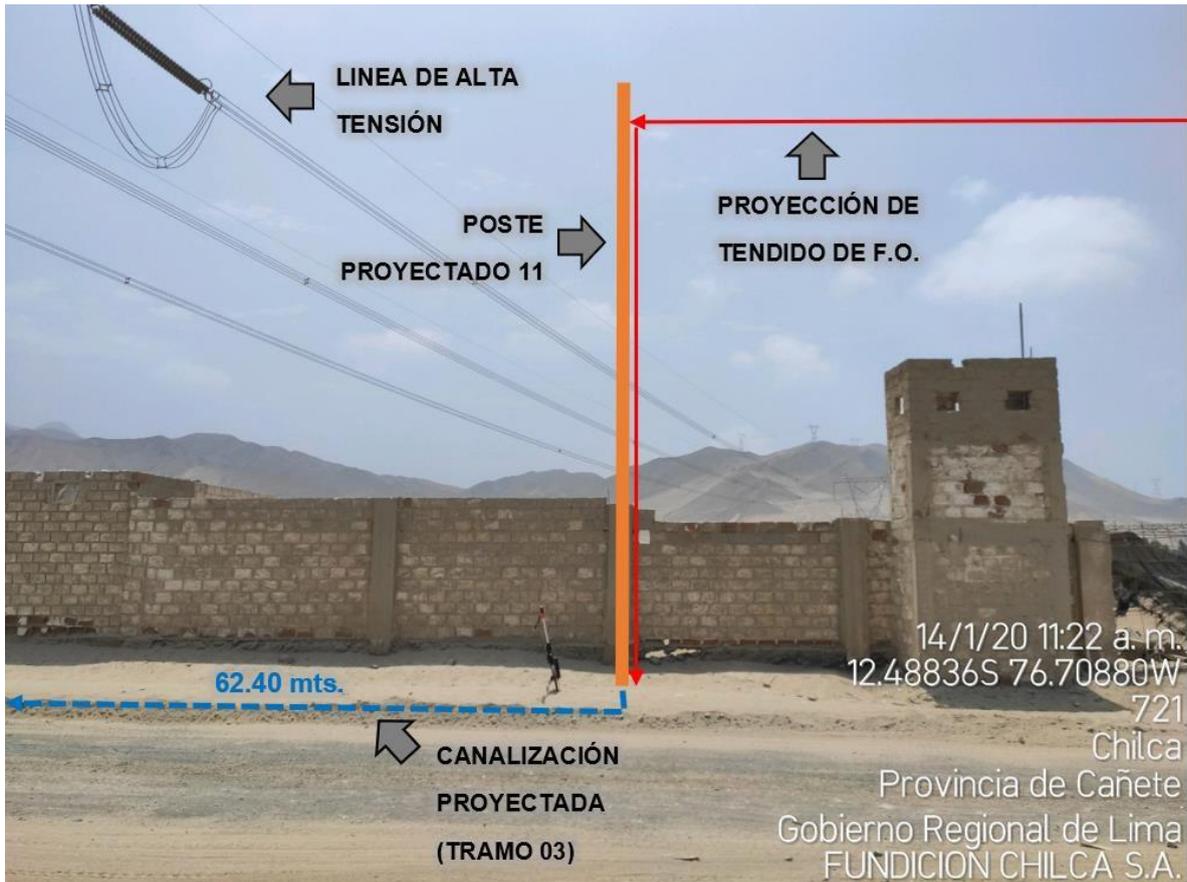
Poste proyectado 11 y tercer tramo de canalización proyectada
